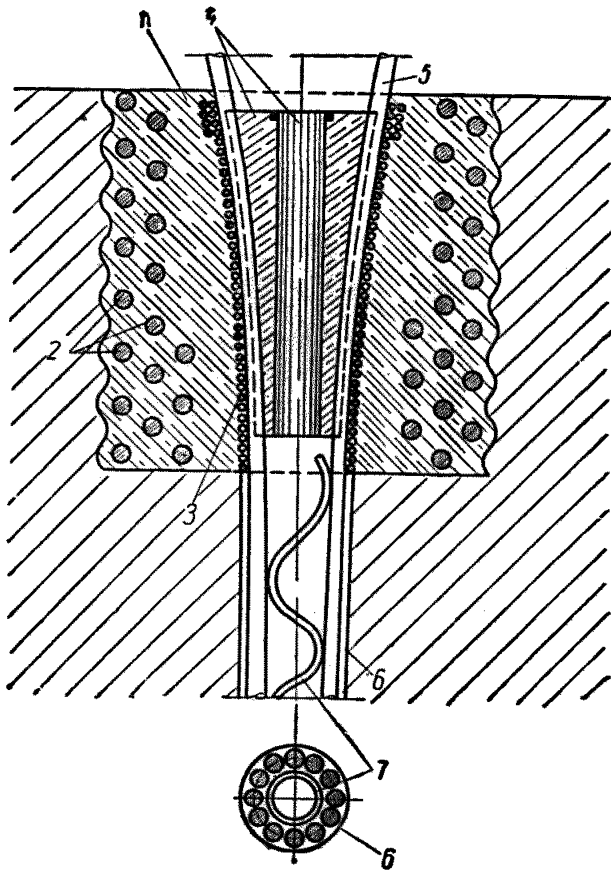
Анкеровка арматурного пучка при помощи железобетонной колодки и стальной пробки
